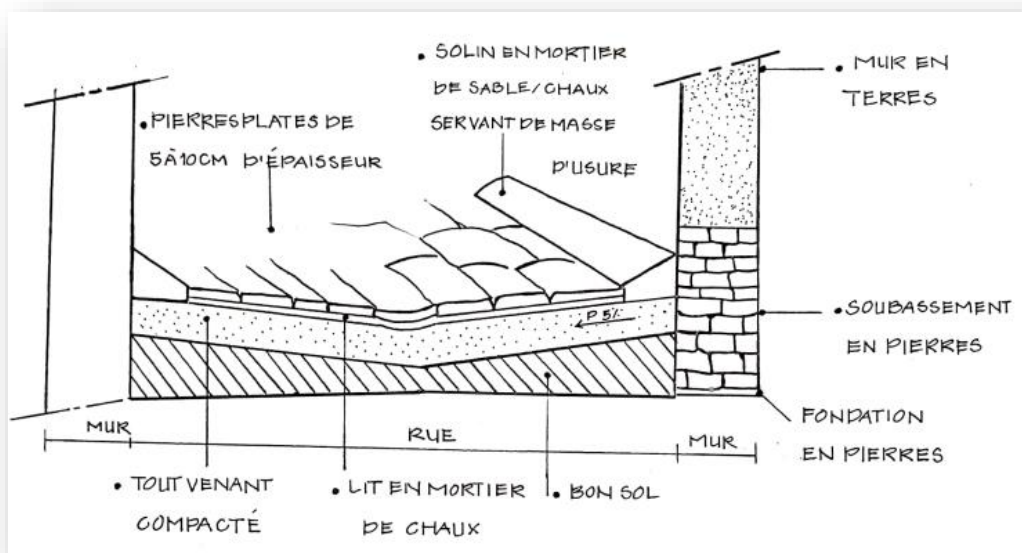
Recouvrement du sol extérieur de dallage et d'une pente pour l'évacuation de l'eau. Source : Auteure. 2022. Adapté de H. Guillaud .2004
